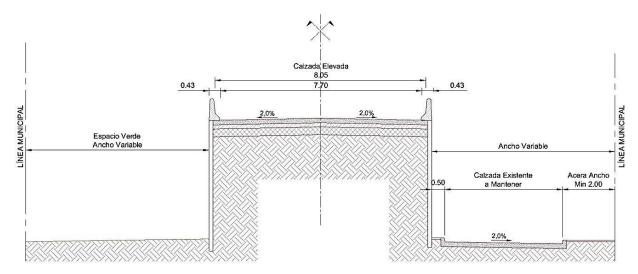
Perfil tipo del viaducto sobre Av. Libertad
